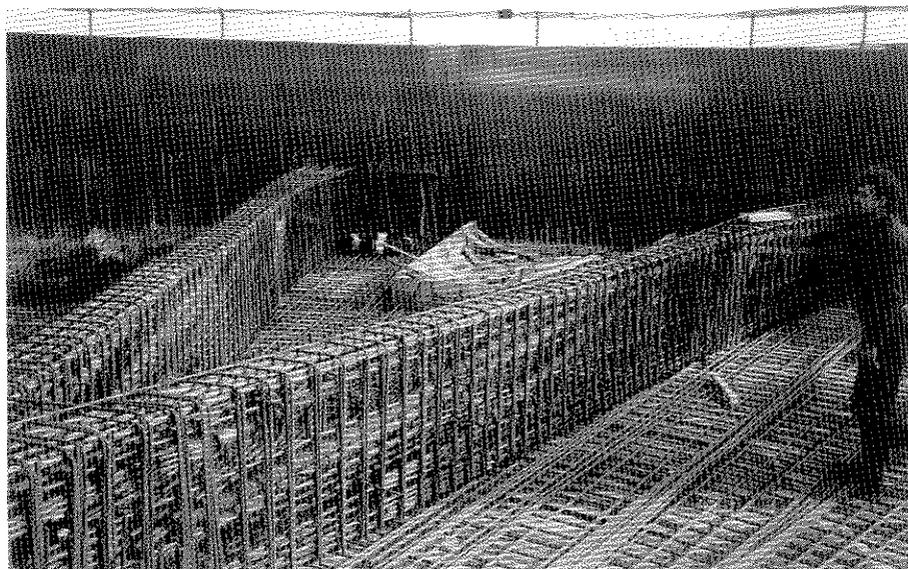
Detalle de armadura de las vigas postensadas de cubierta.
